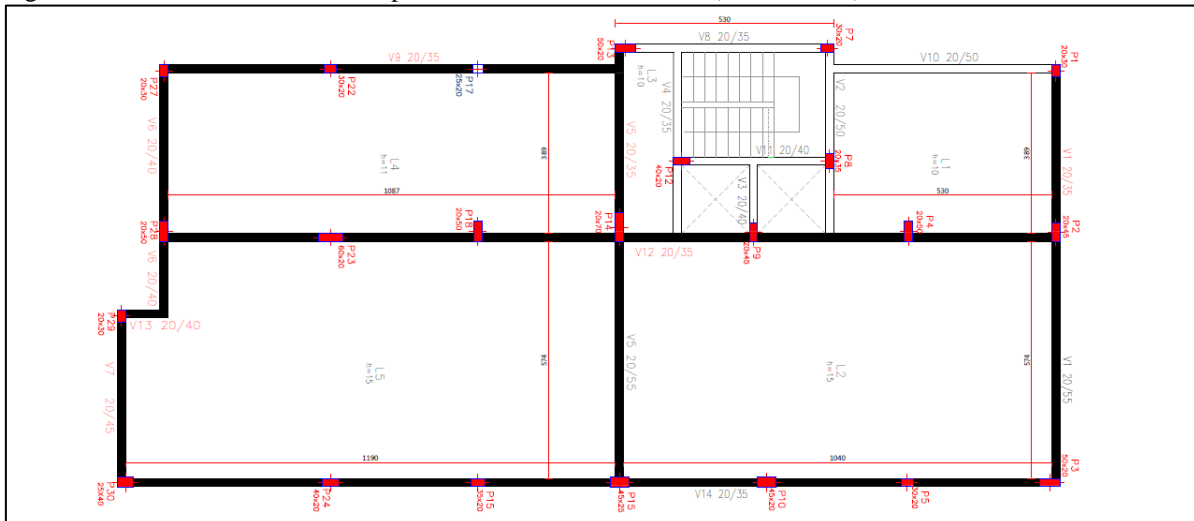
Planta de Forma Pav. Tipo – Modelo 01 – Com vento (cotas em cm)
